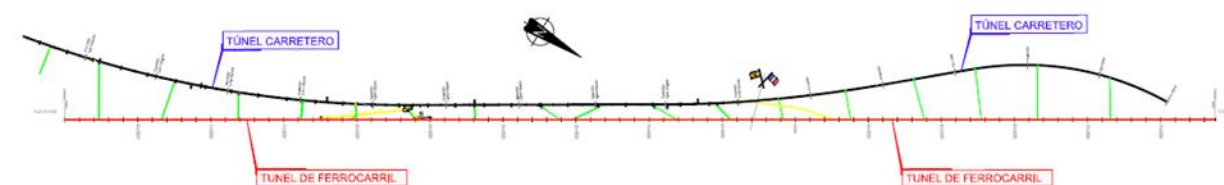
Planta de túneles ferroviario y de carreteras de Somport.
